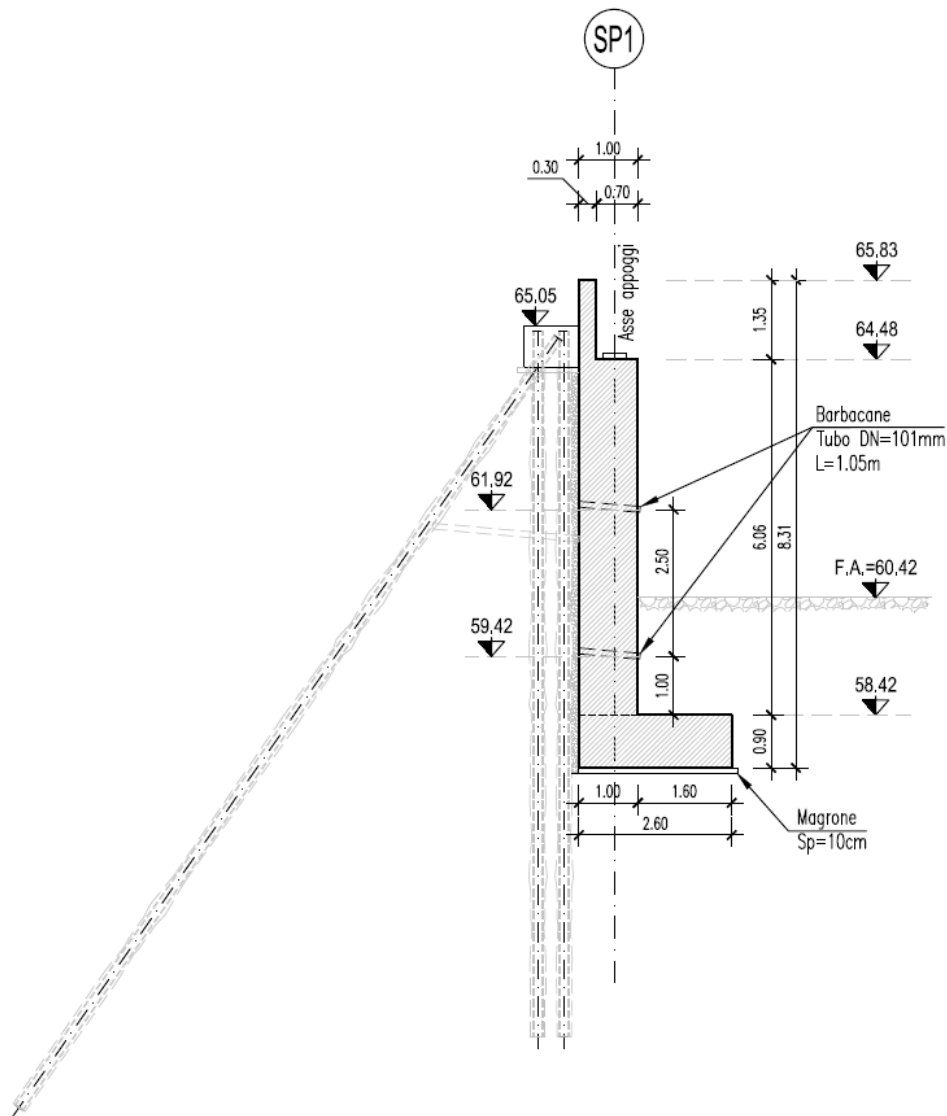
Ponte1, Spalla, schema carpenteria
